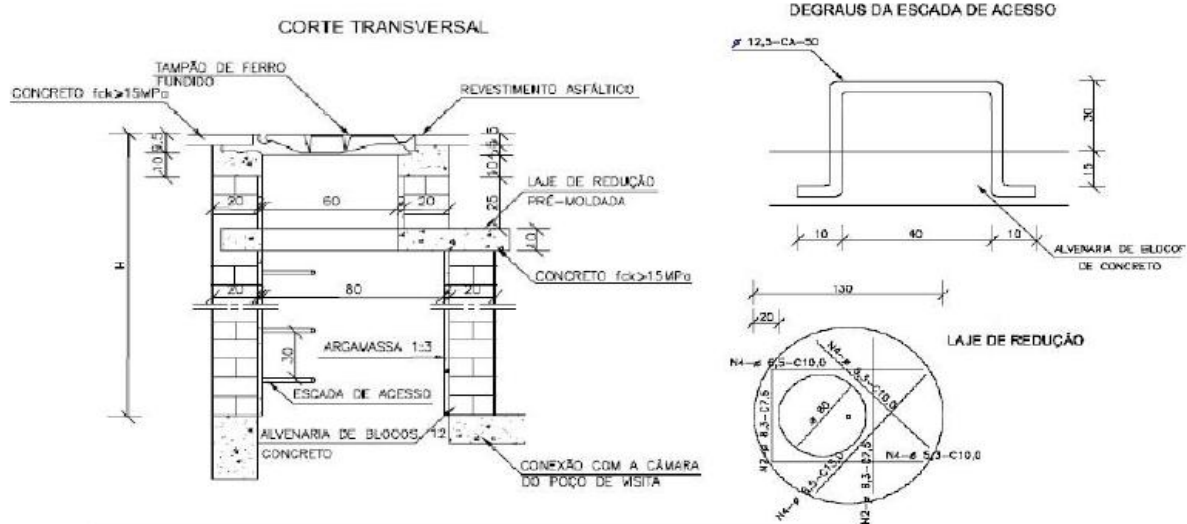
REPRESENTAÇÃO EM PLANTA E CORTE DE CHAMINÉ
